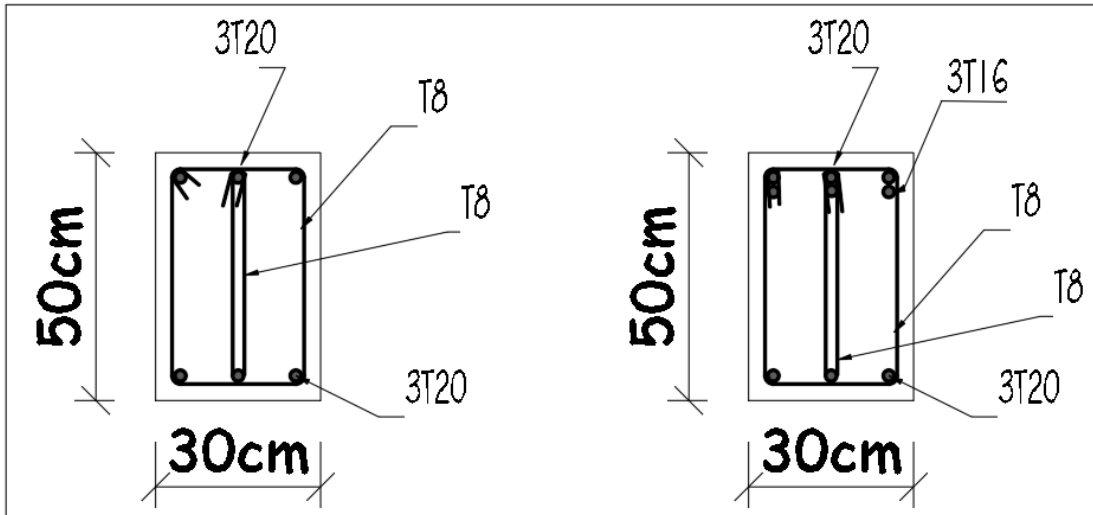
Ferraillage de la poutre secondaire du 3ème au 5ème étage
